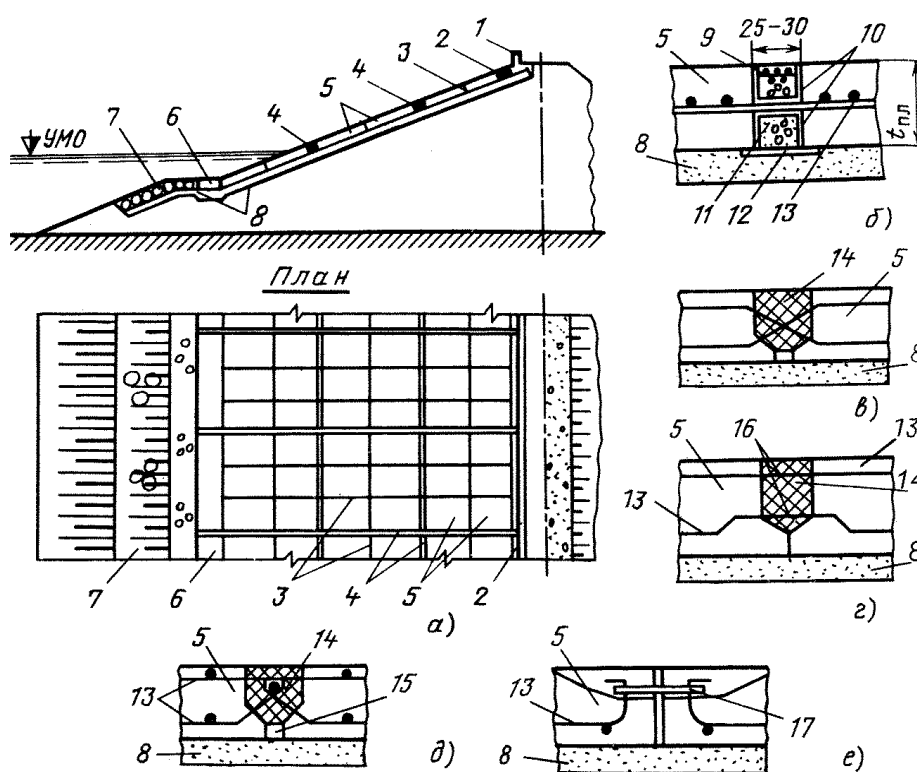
Крепление верхового откоса земляных плотин сборными железобетонными плитами:
